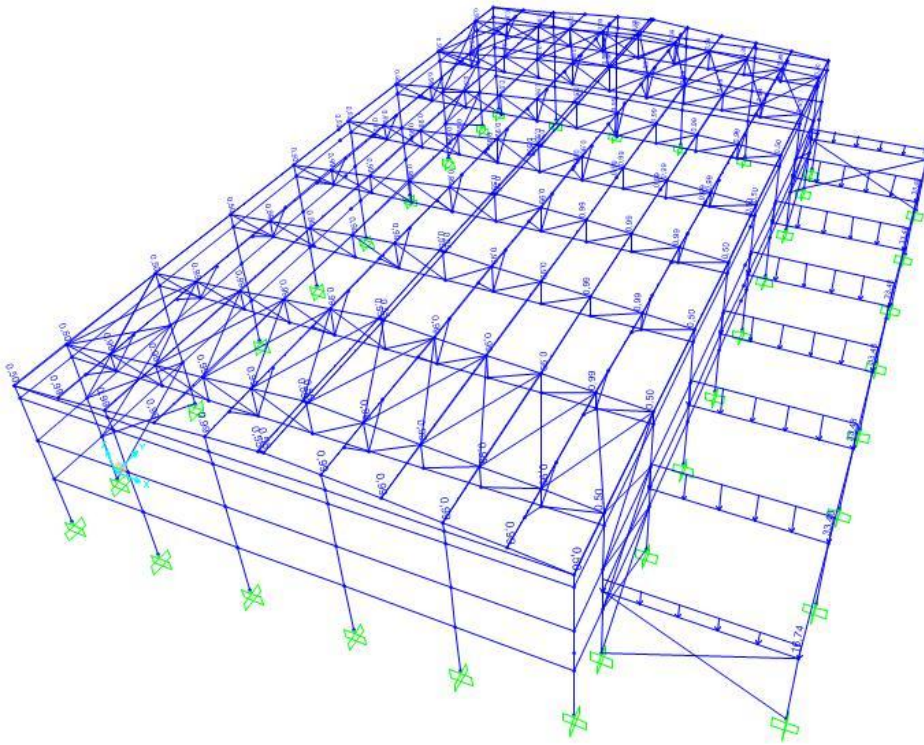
Estructura bajo la acción de la sobrecarga de uso (SAP2000).
